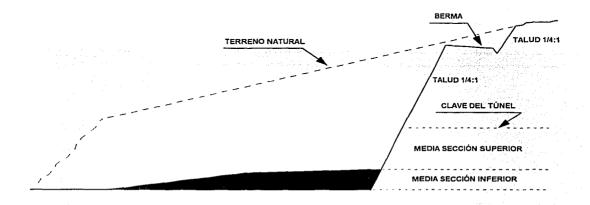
Rampa de rezaga para alcanzar la media sección superior
